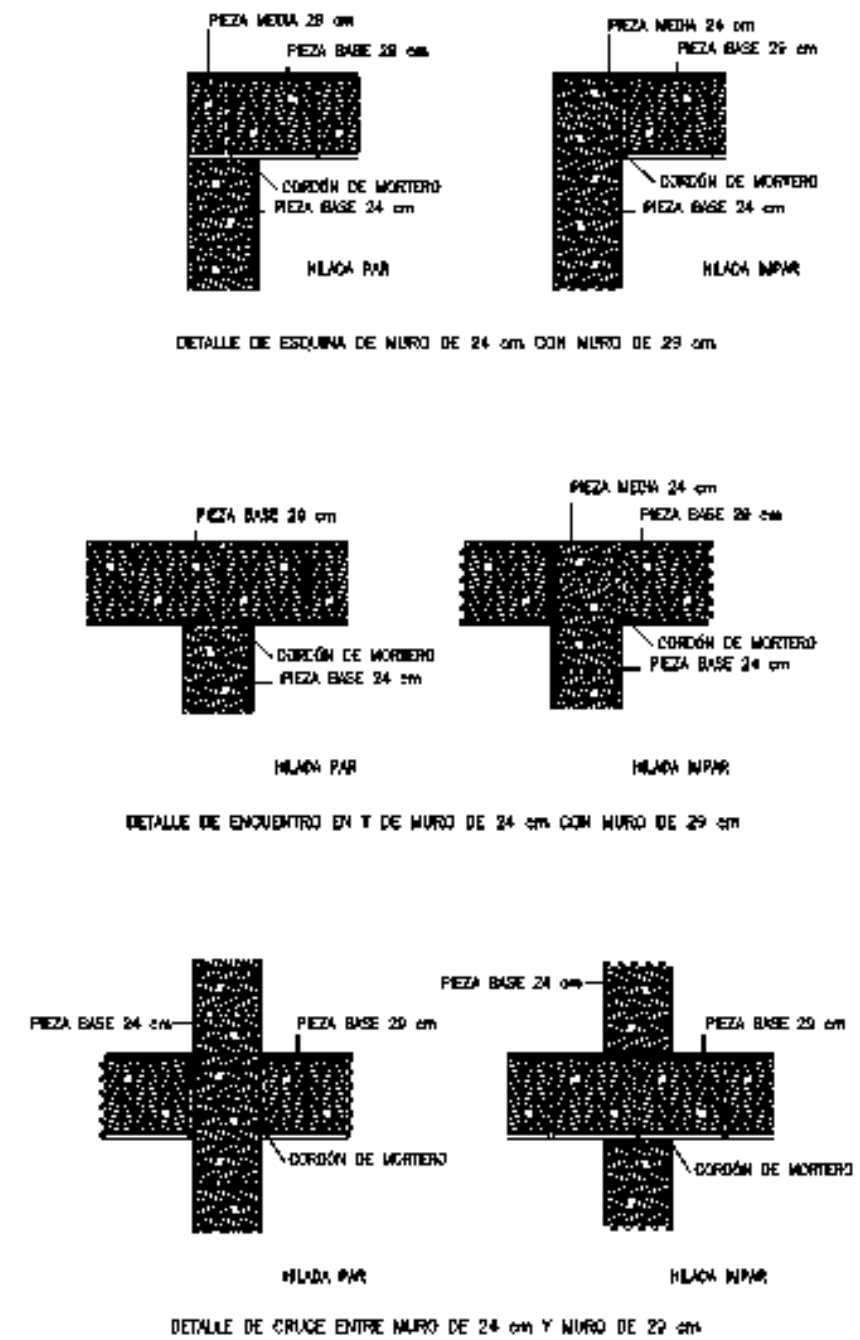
Detalles de encuentro de piezas de 24 cm con piezas de 29 cm..
